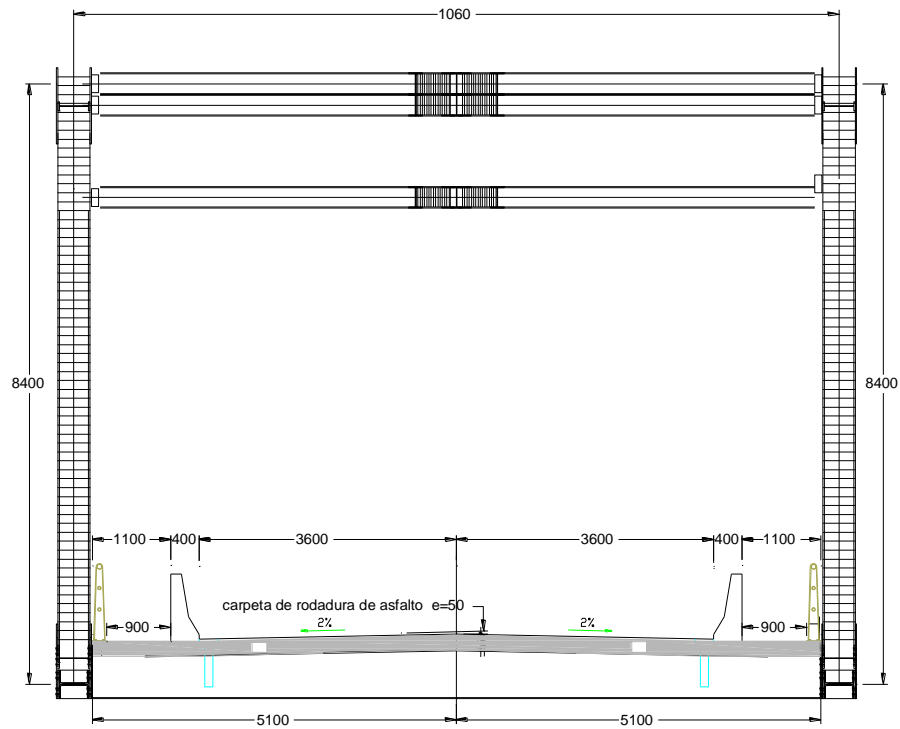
DETALLE DE LA SECCION TRANSVERSAL
